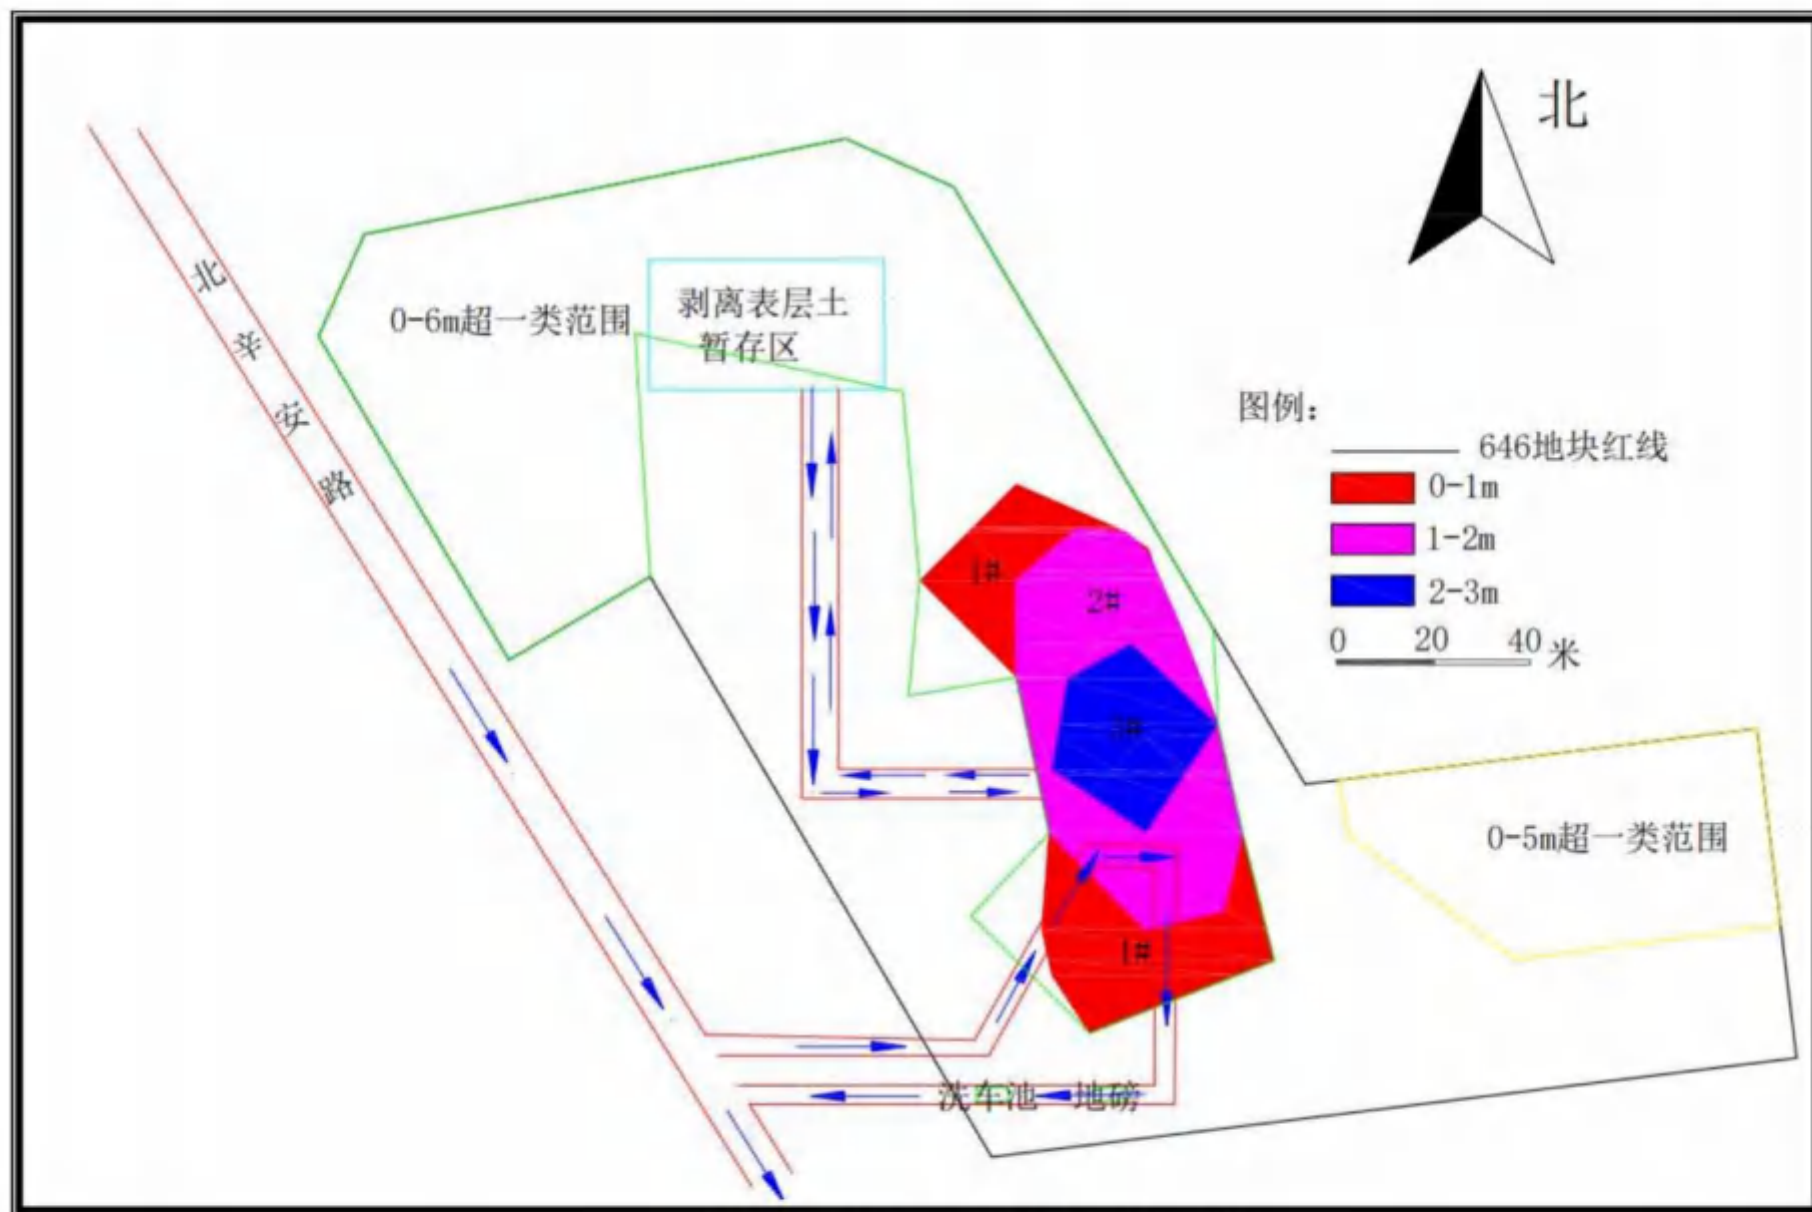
1608-646 地块现场实际清挖平面图
